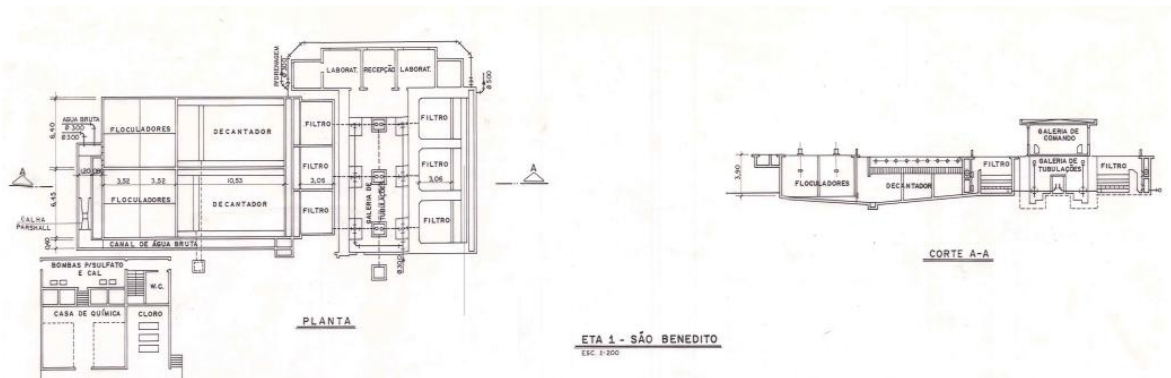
Planta e corte das unidades de tratamento da ETA 1
